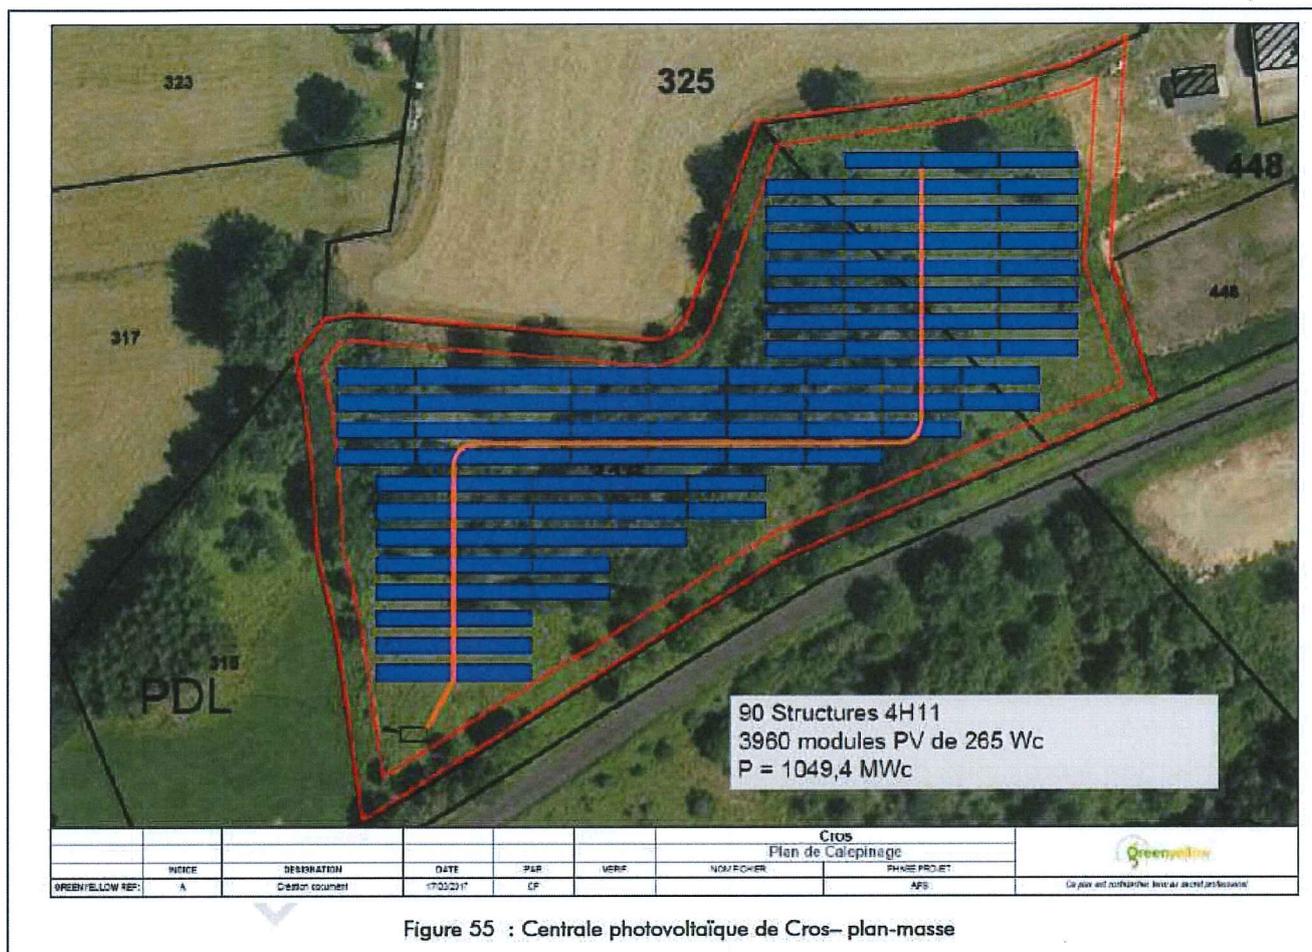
Centrale photovoltaïque de Cros– plan-masse
